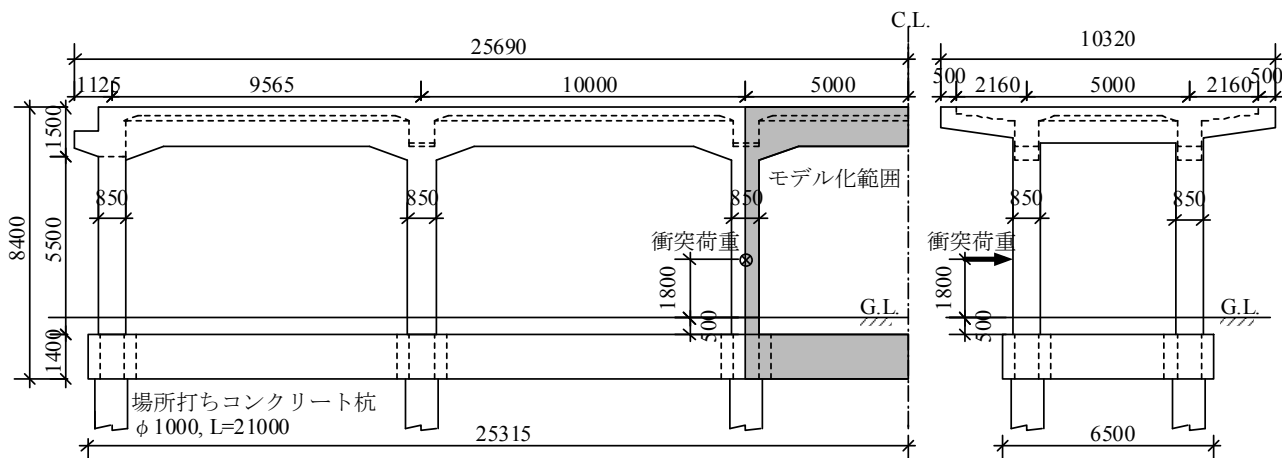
鉄道 RC ラーメン高架橋の構造一般図 (単位 : mm)
